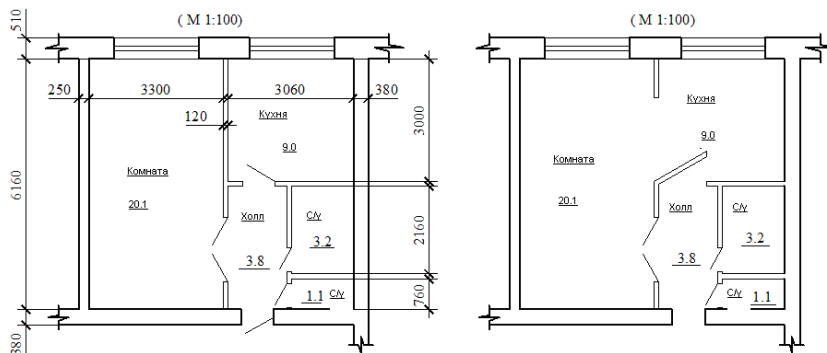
Второй вариант перепланировки однокомнатной квартиры
